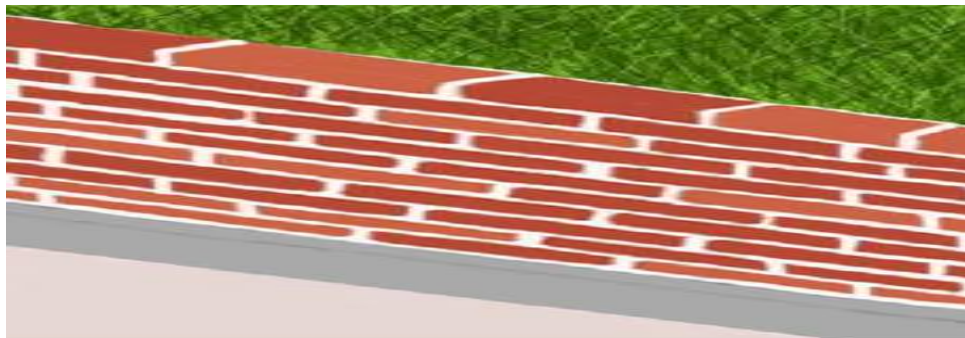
Excavar en la base del muro (Fuente: Silva 2014)
